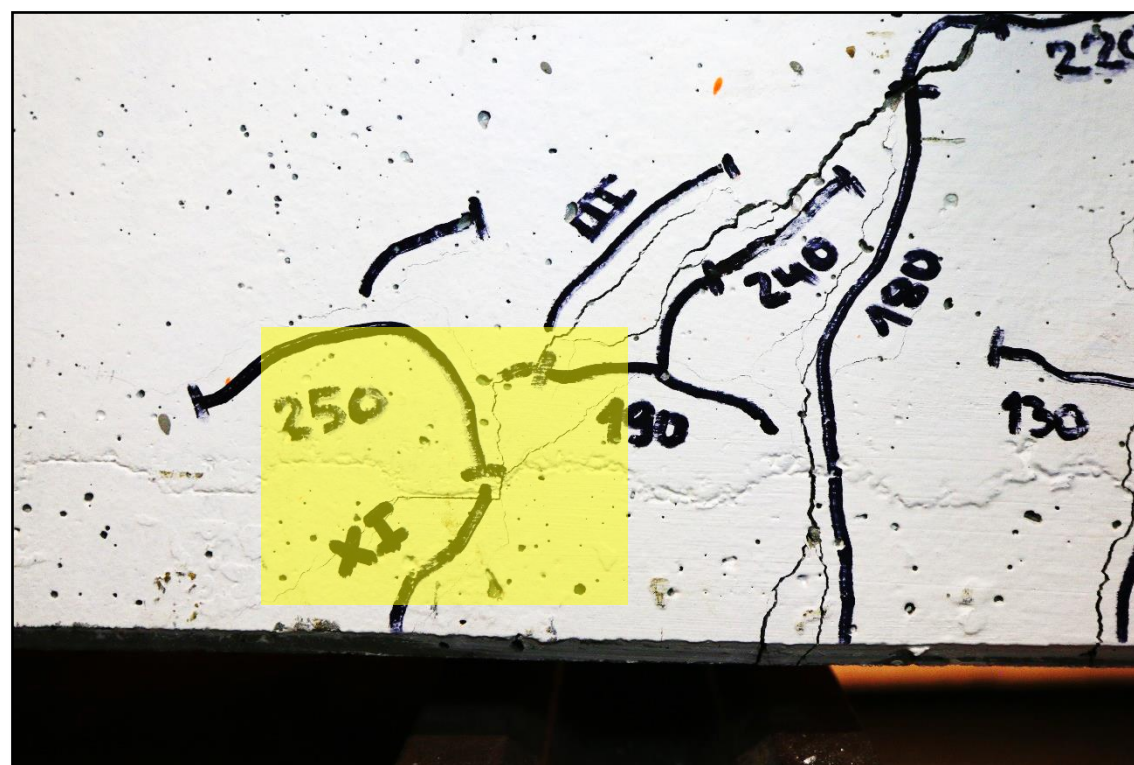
Porušenie D1 – vzadu vpravo detail
